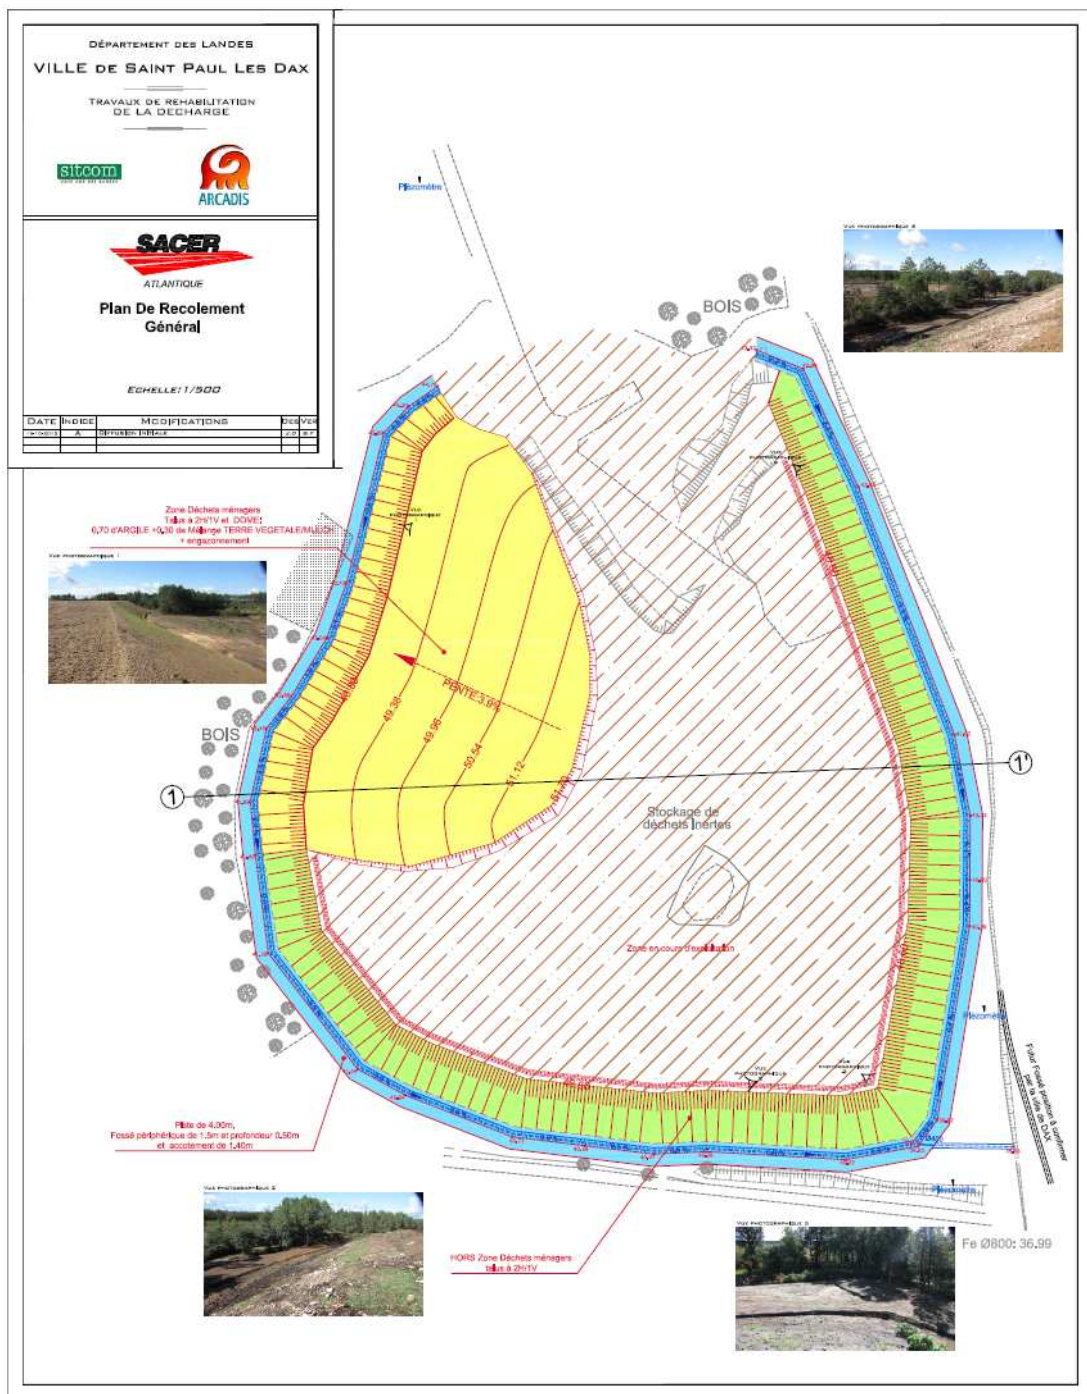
Plan de recollement général, source : Rapport de Travaux, Arcadis
